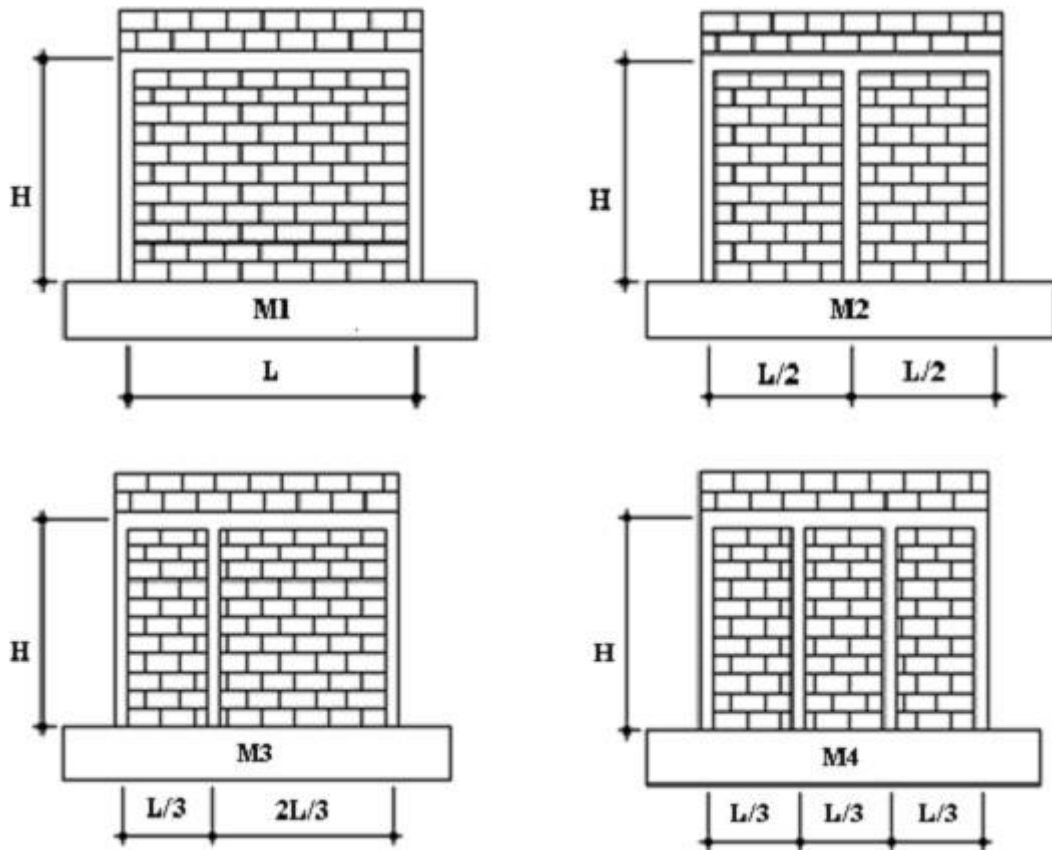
Configuração das paredes ensaiadas (Marinilli e Castilla (2007)).
